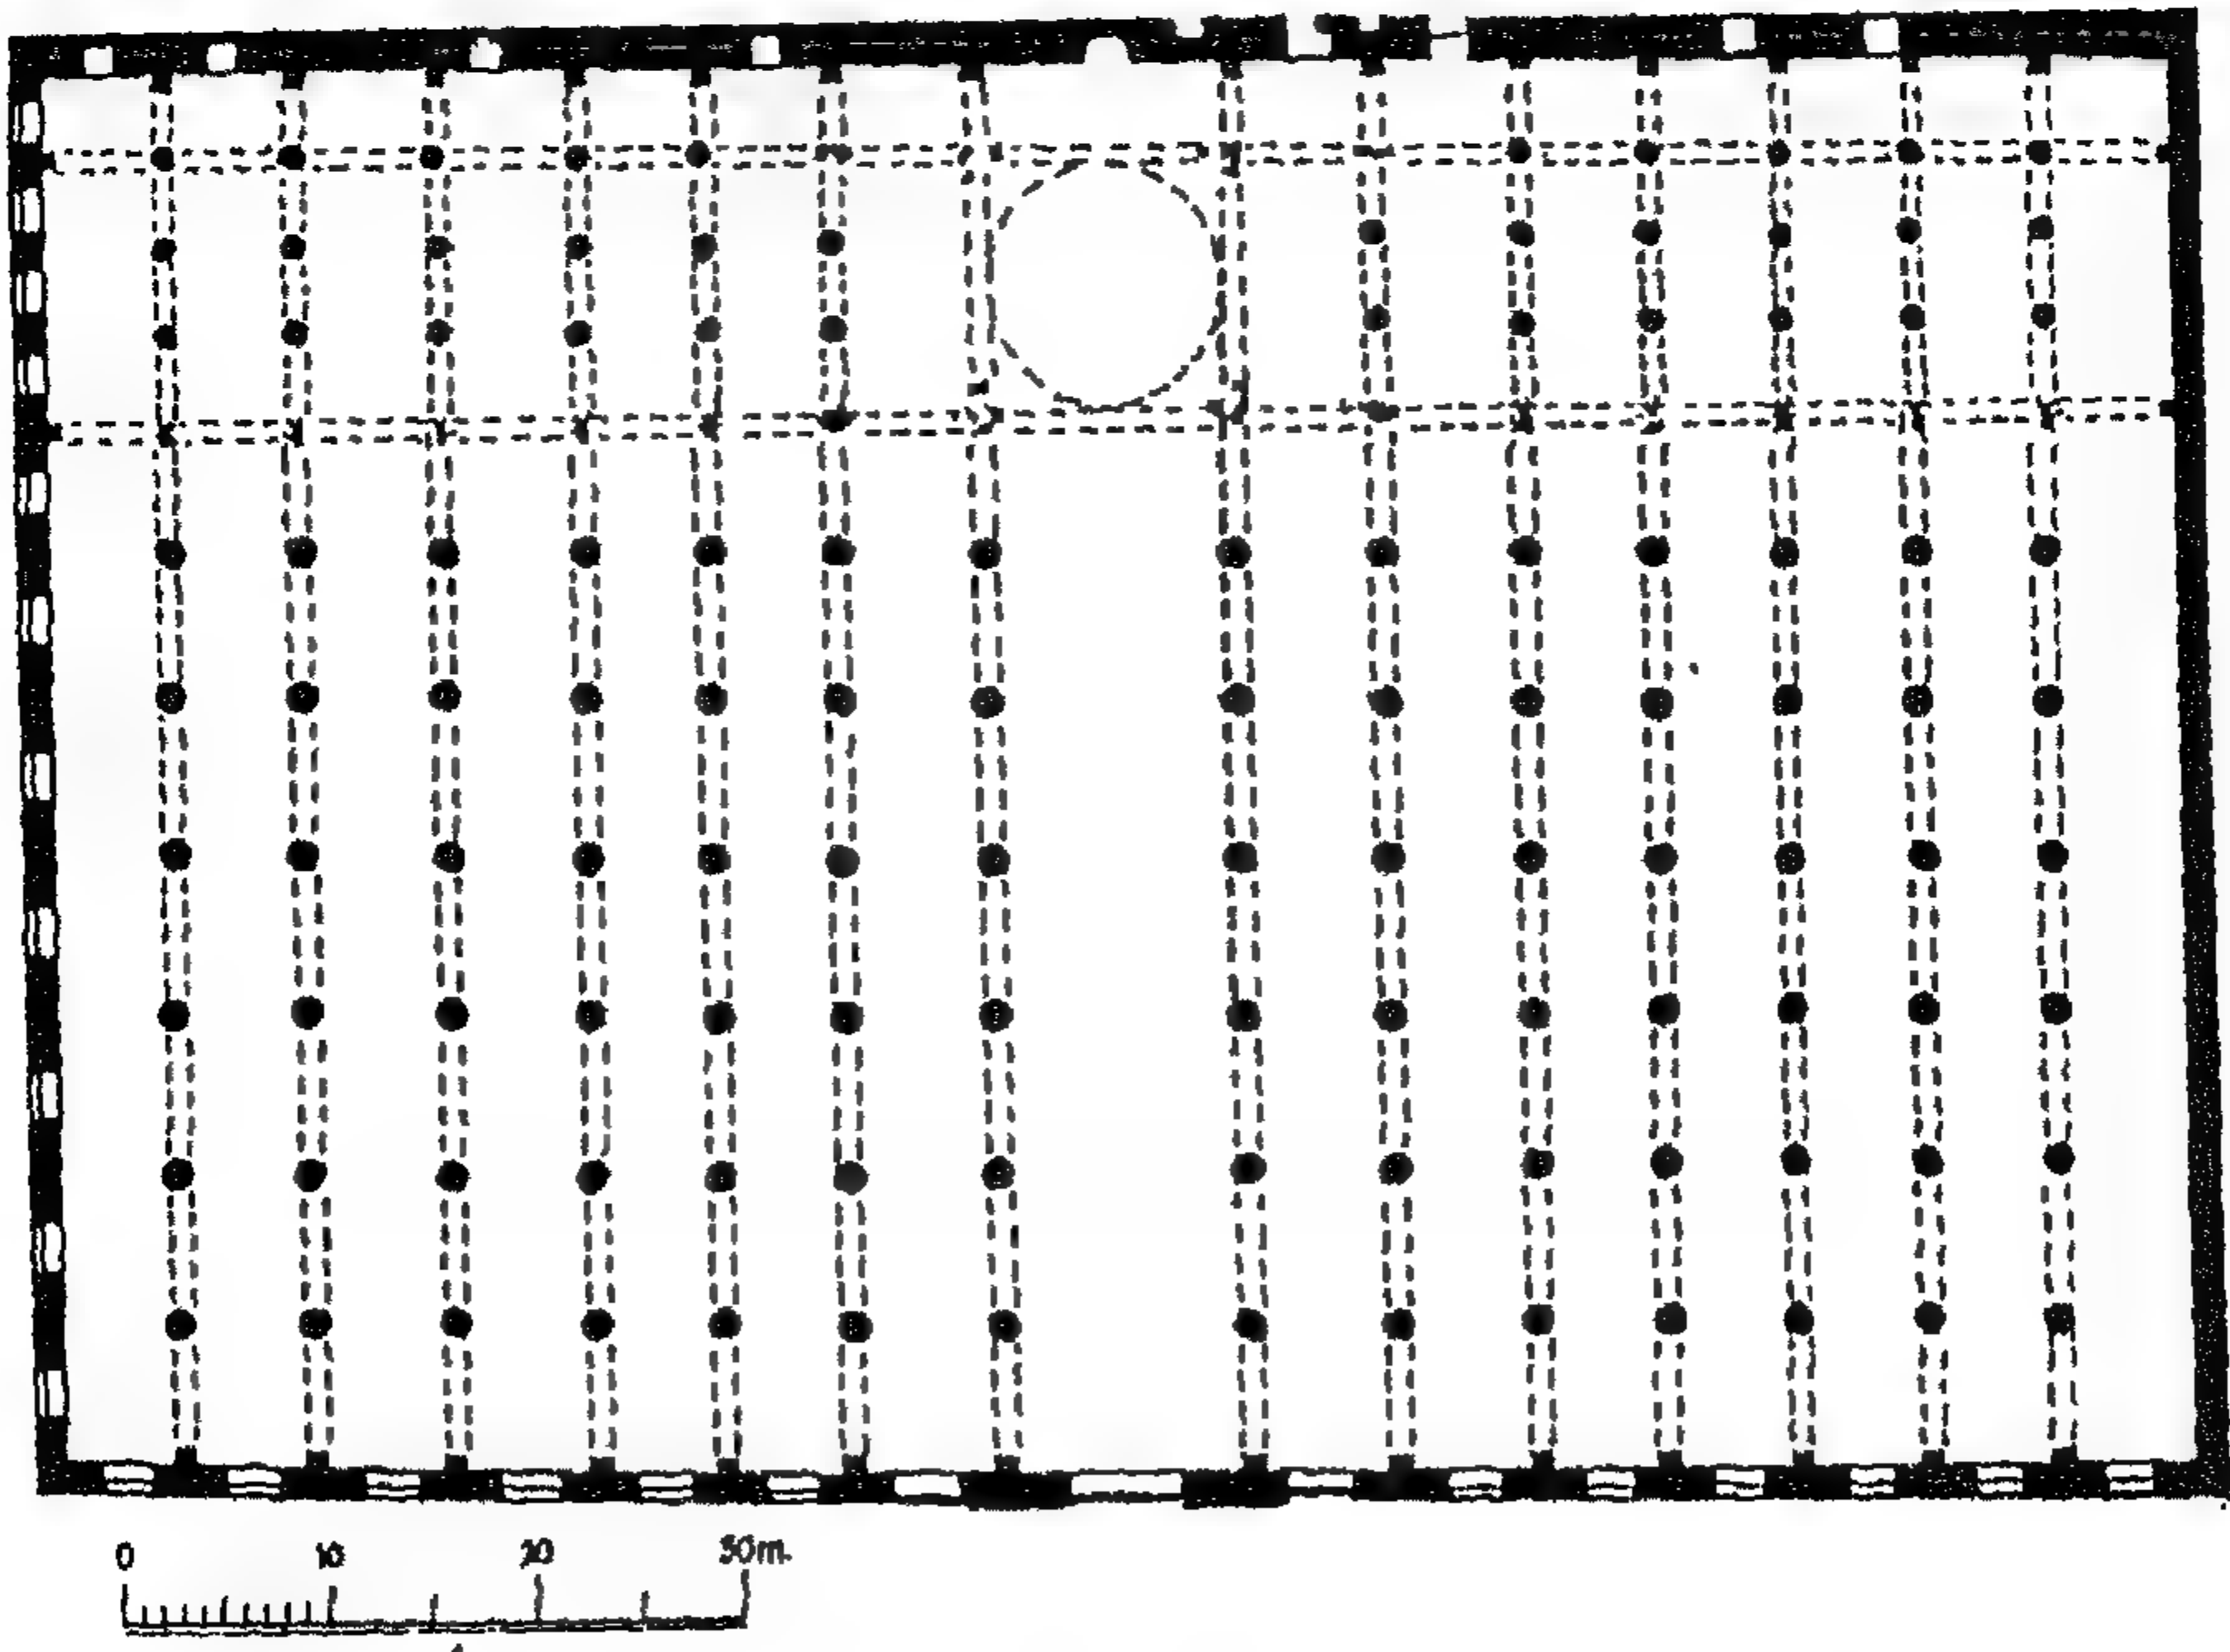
مسقط أفقي للجامع المنصوري الكبير بطرابلس الشام بليمان
